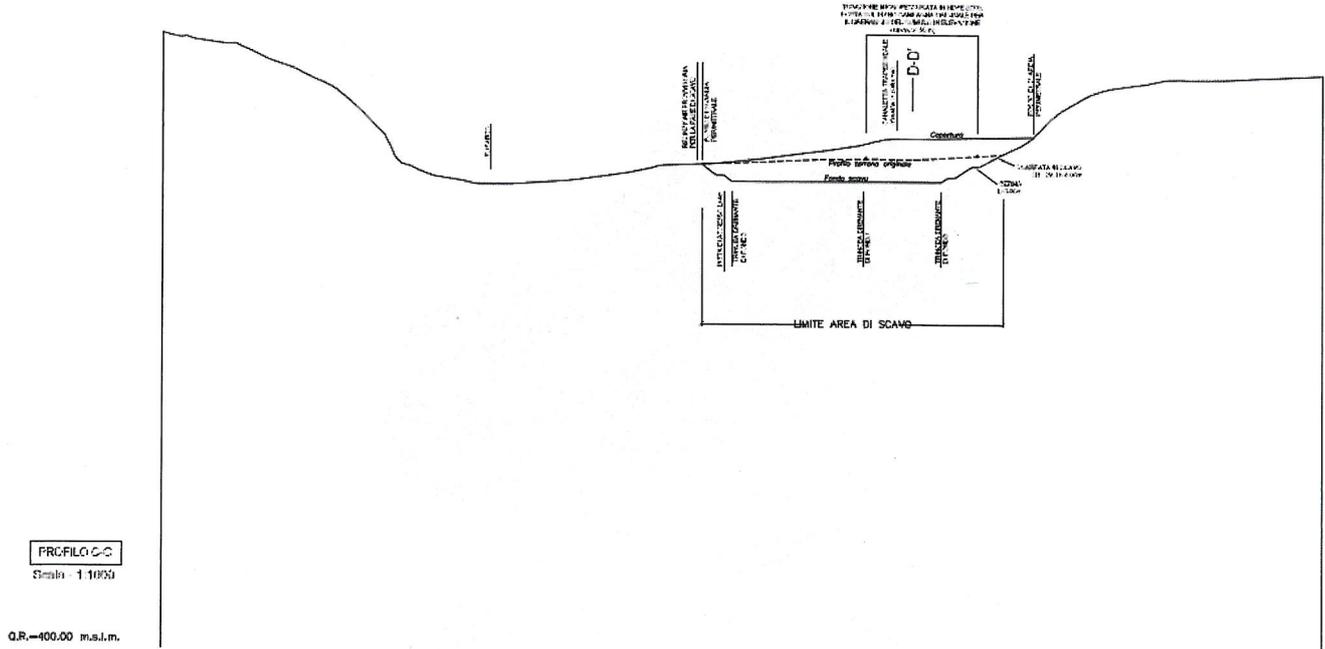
Depositi definitivi in Val Riga - B - Plaikner - Sezione trasversale C-C
